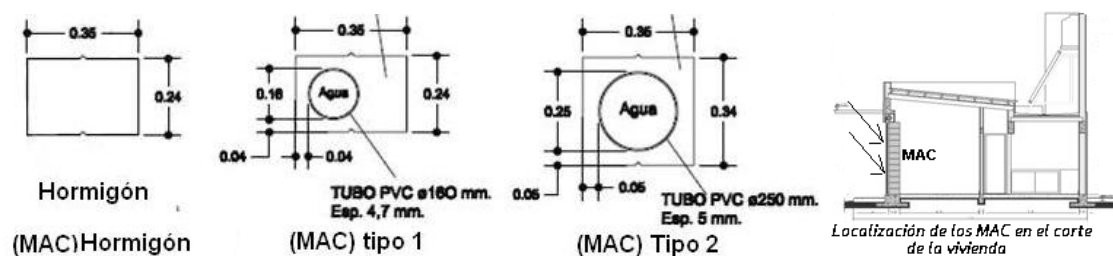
Corte transversal de las piezas que constituyen los tres tipos de MAC y corte transversal de la vivienda con la localización del MAC en la fachada norte.
